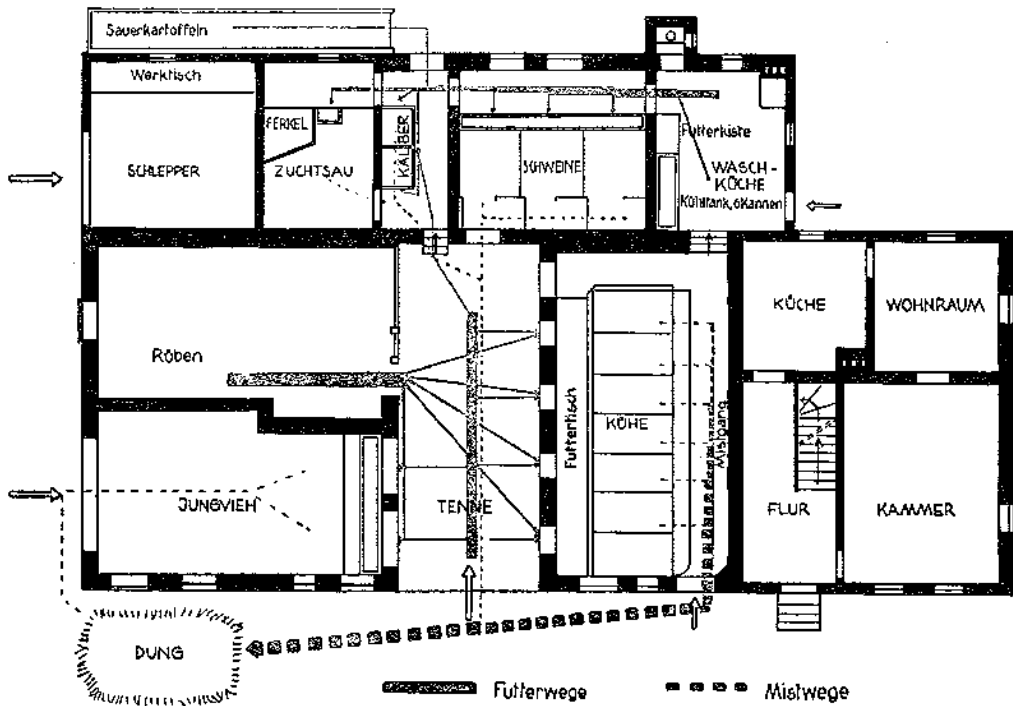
Gebäudegrundriß im Betrieb von 9 ha nach dem Umbau Dorf H
